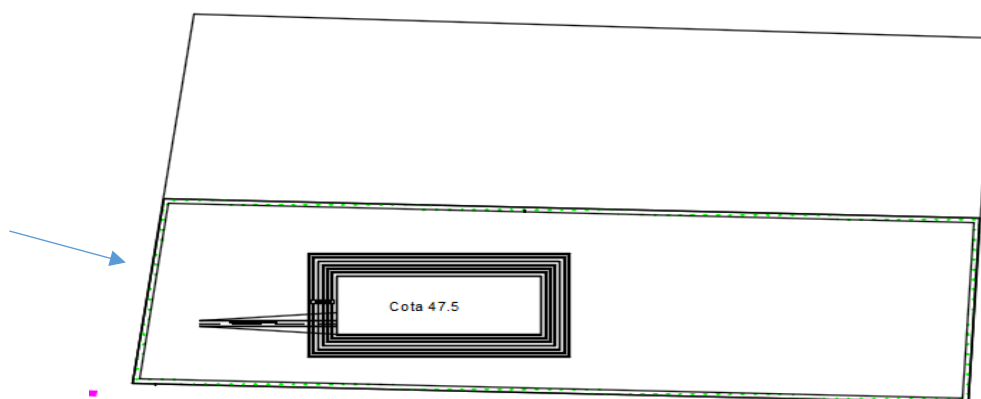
Detalle de la segunda zona de excavación (zona perimetral al relleno).
